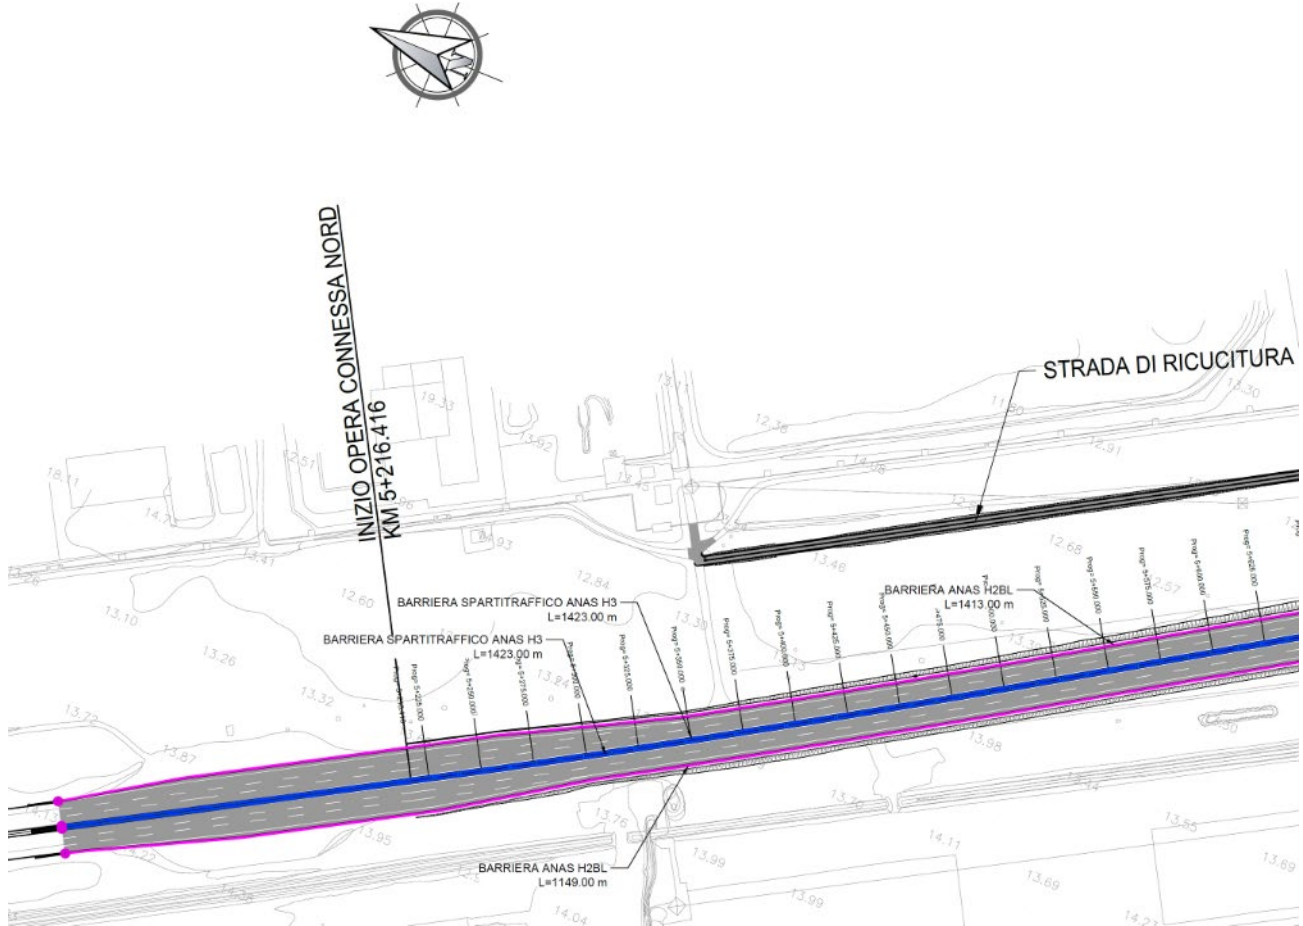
Stralcio Sistemazione corsie specializzate e piazzali esistenti (Planimetria barriere di sicurezza dal km 5+216 al km 6+900)
